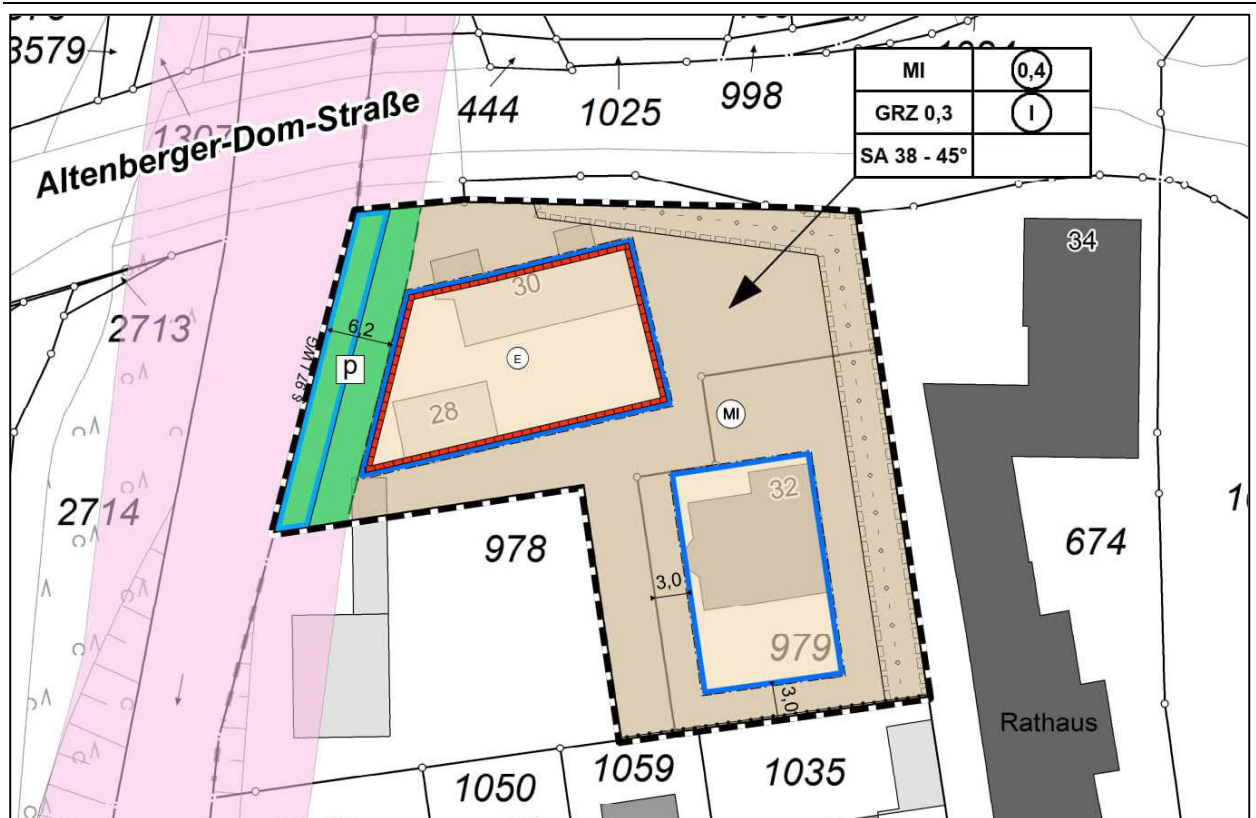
Bebauungsplan Nr. 44B, 4. Änderung (Quelle: Gemeinde Odenthal)
